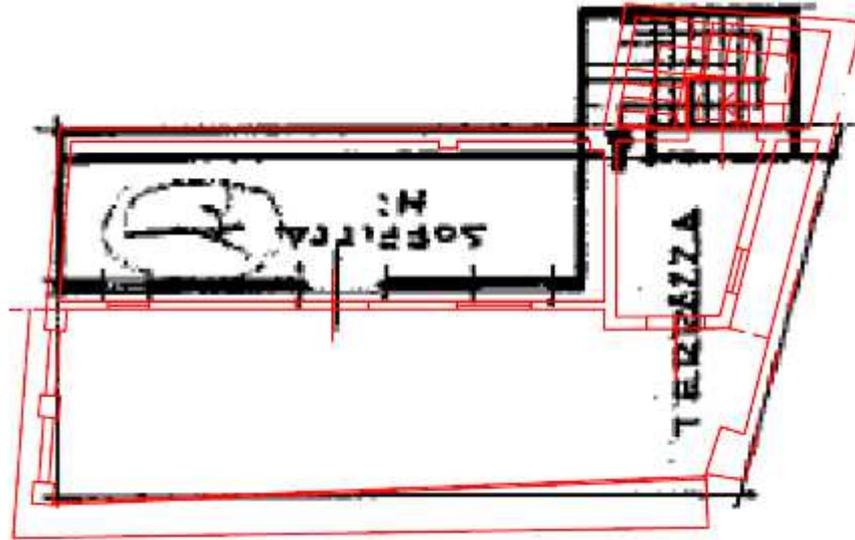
Sovrapposizione tra lo stato attuale - planimetria catastale, sub. 1 (p.3).
